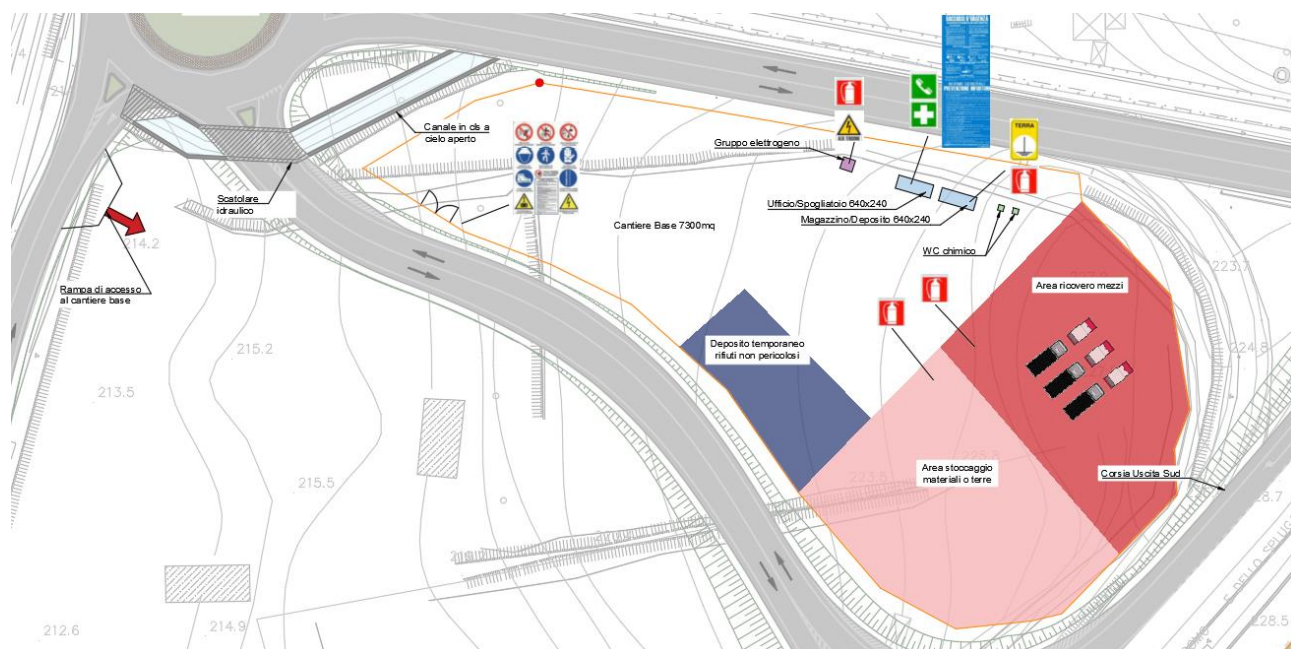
Planimetria di progetto di ubicazione del cantiere
